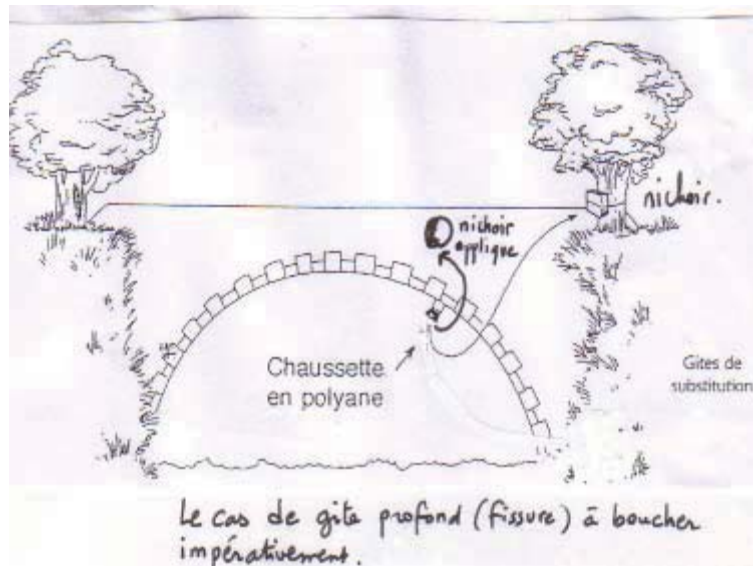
exemple de conduite à tenir lors de la destruction d'un ouvrage
